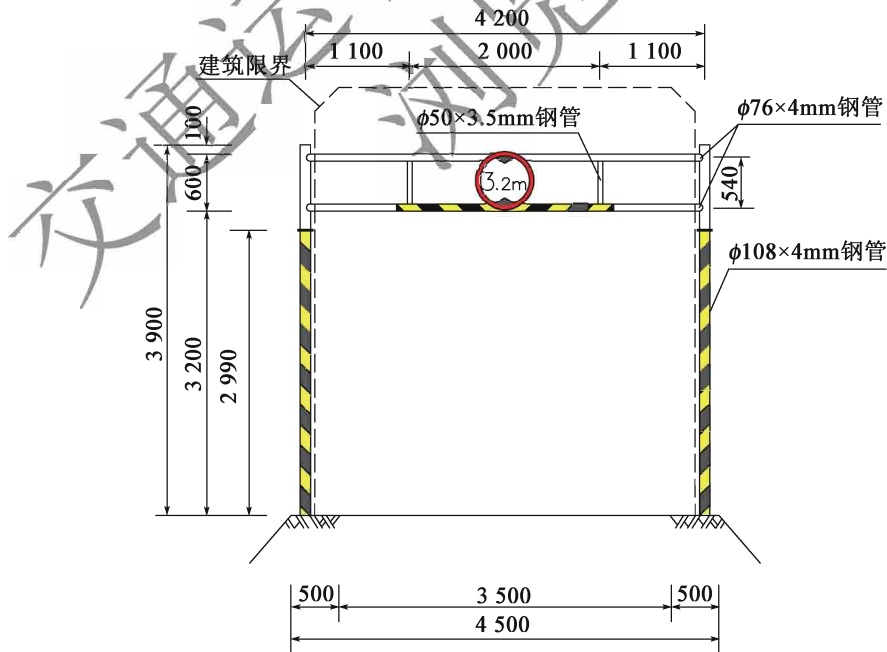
防撞限高架结构示意一(尺寸单位: mm)
